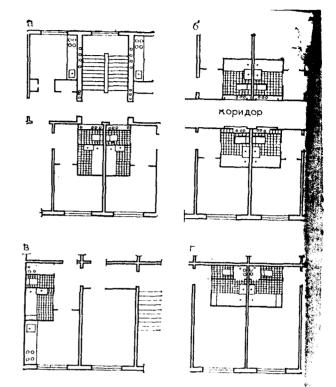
, Примеры размещения саптехнических помещений планах объемно-блочных зданий
